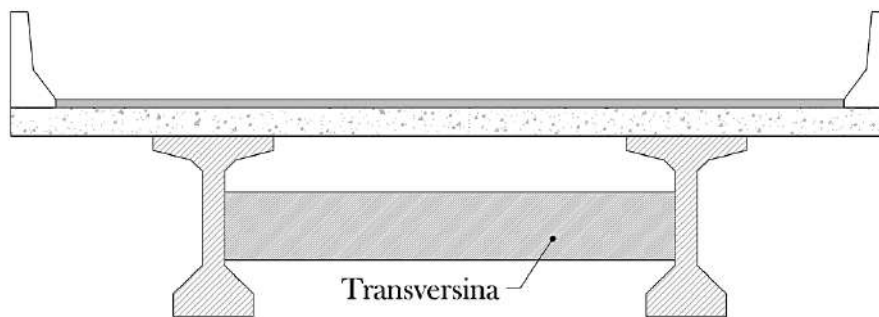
Viga transversina enrijecendo o sistema da superestrutura. Fonte: adaptado de Cavalcante, 2019
